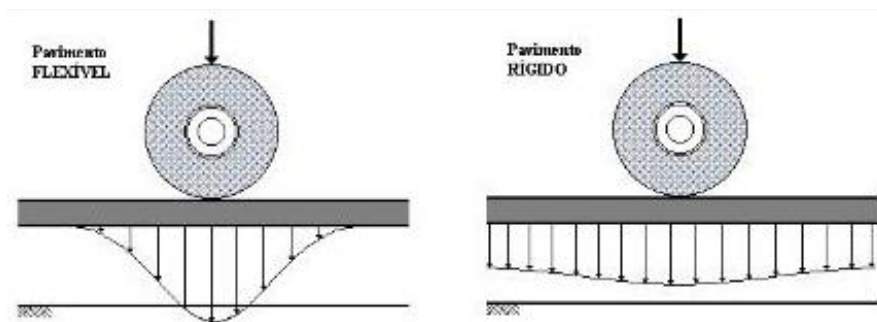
Comparação das Tensões Entre o Pavimento Flexível e Rígido (Fonte: ebah, 2014)
